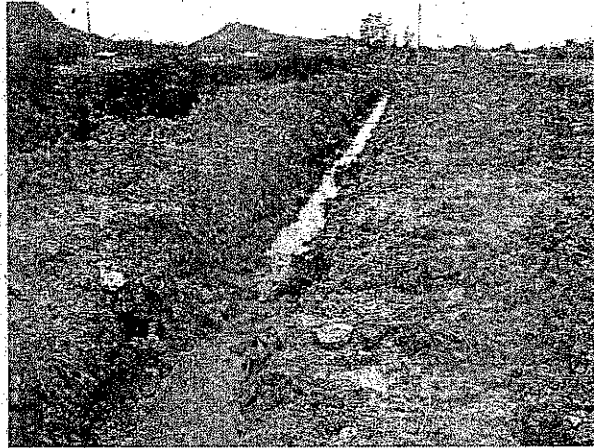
Canalêta de drenagem implantada junto à área de aterro.
